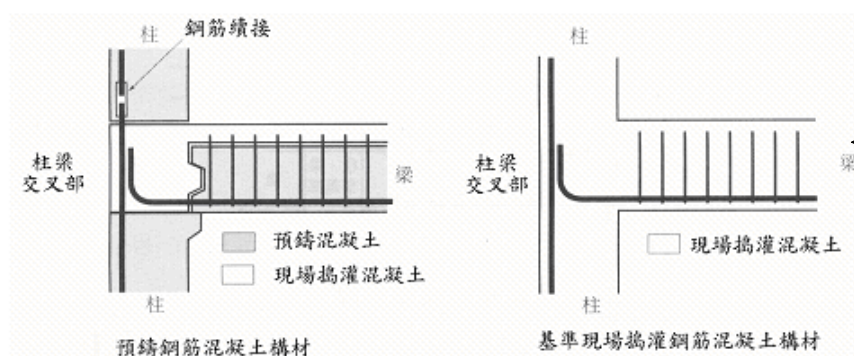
現場澆置鋼筋混凝土構材的概念
